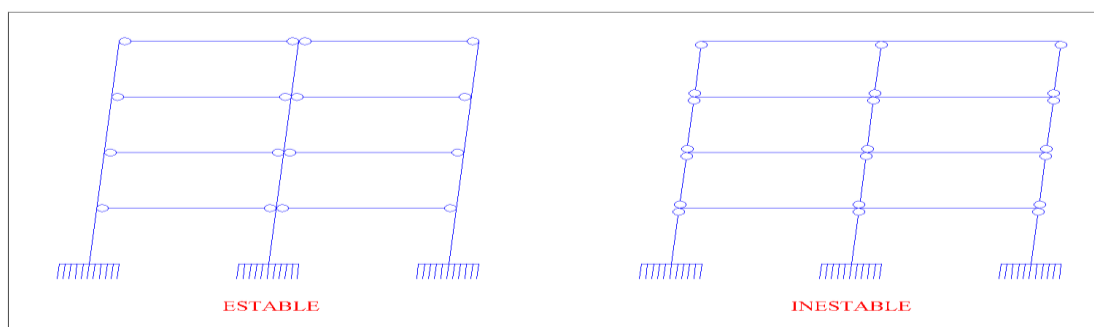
Mecanismos de fallas de sistemas aporticados (Fuente: “Diseño en Concreto Armado”. Instituto de la Construcción y Gerencia. Lima, Perú, 2006)
